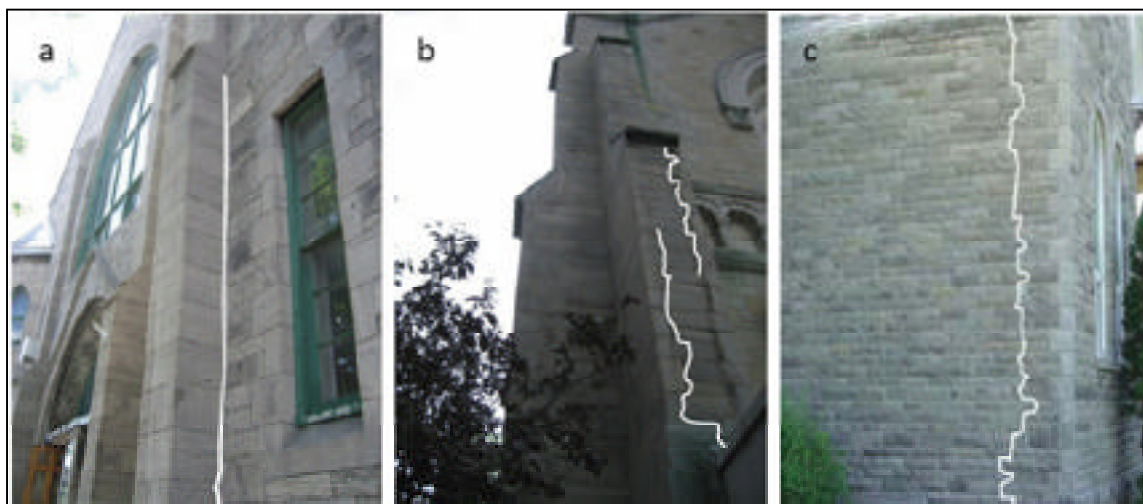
Fissuration type : a) détachement de contrefort, b) mouvements horizontaux de la pierre, c) fluage de la façade.
